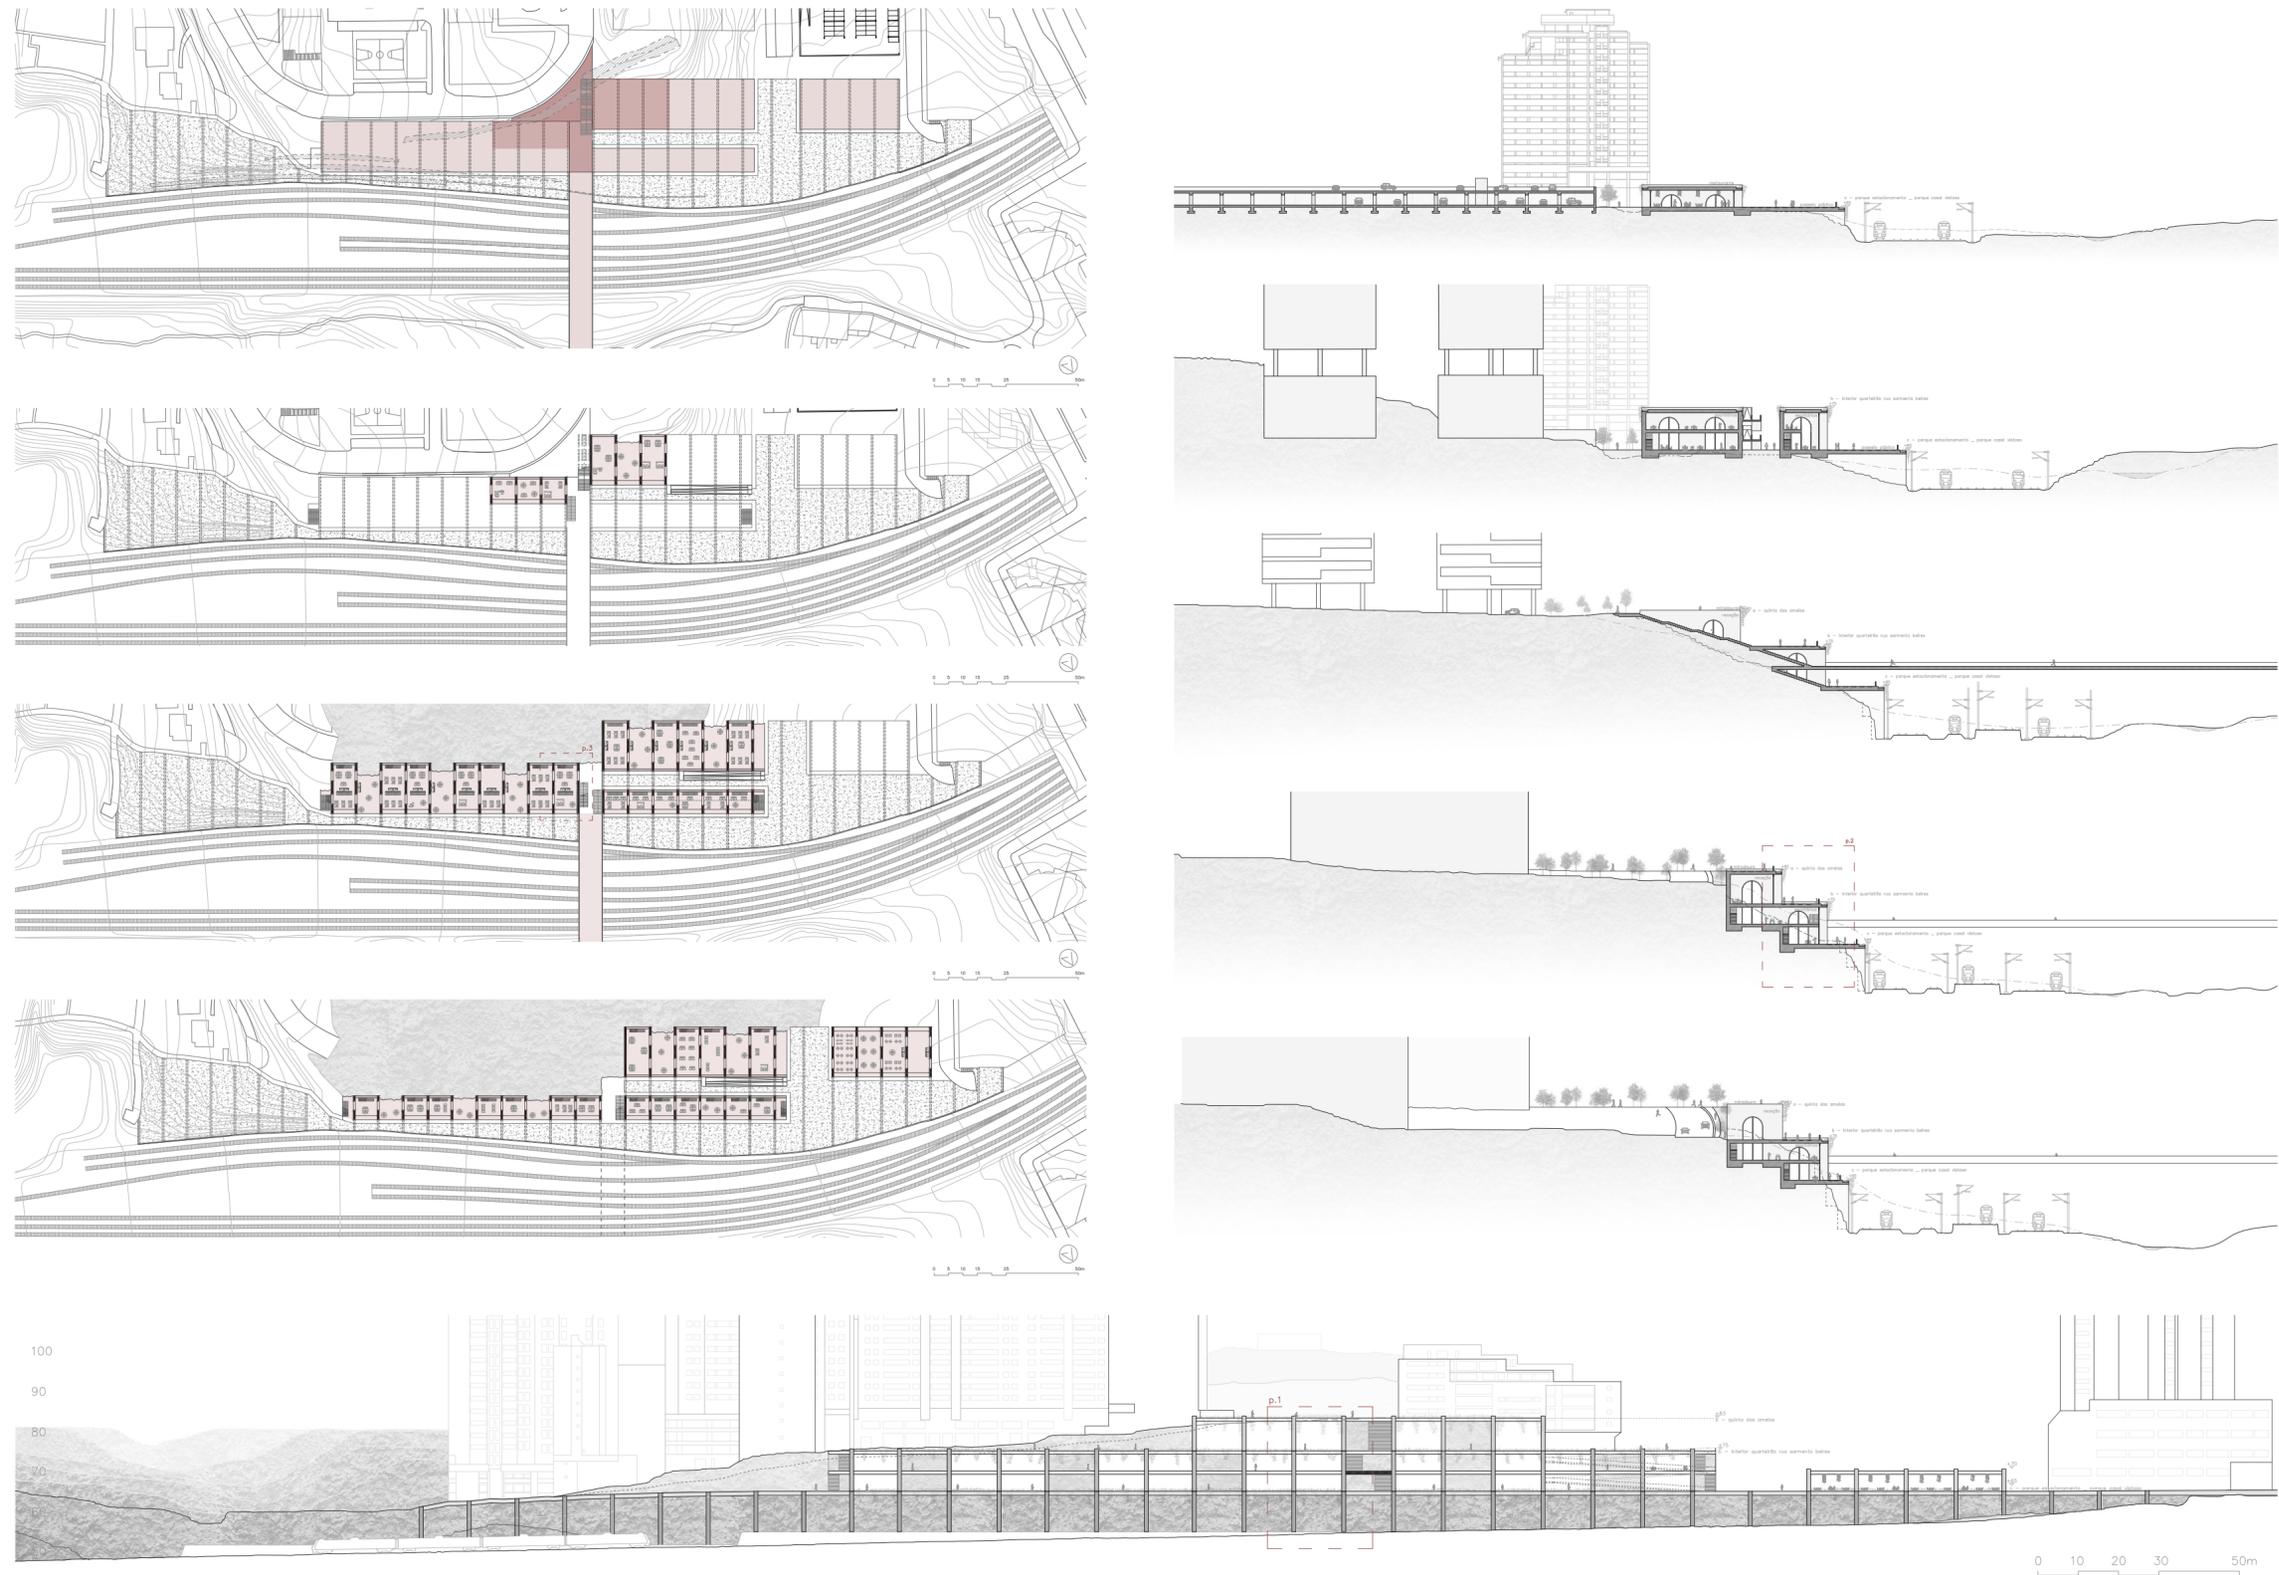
Conjunto de plantas, cortes e alçado com implantação da proposta
